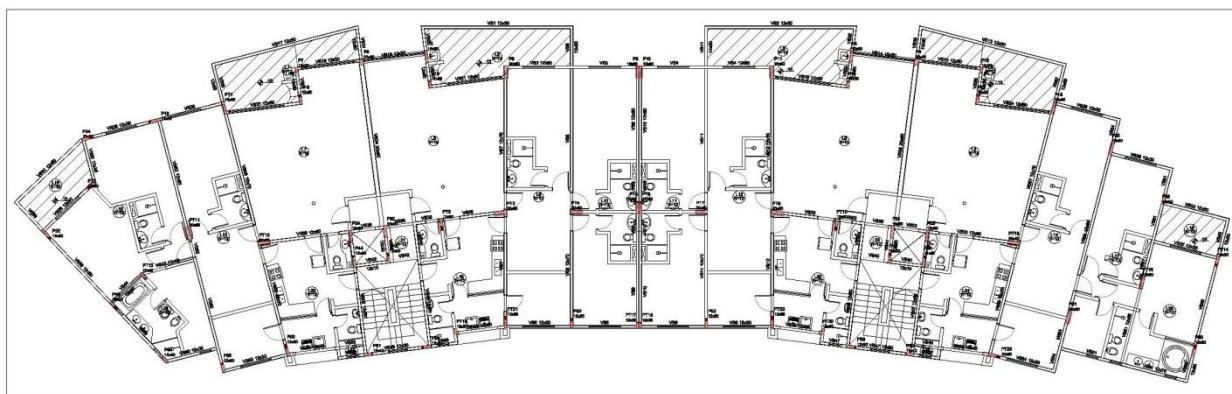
Planta de forma do projeto estrutural do pavimento tipo do bloco 02.
